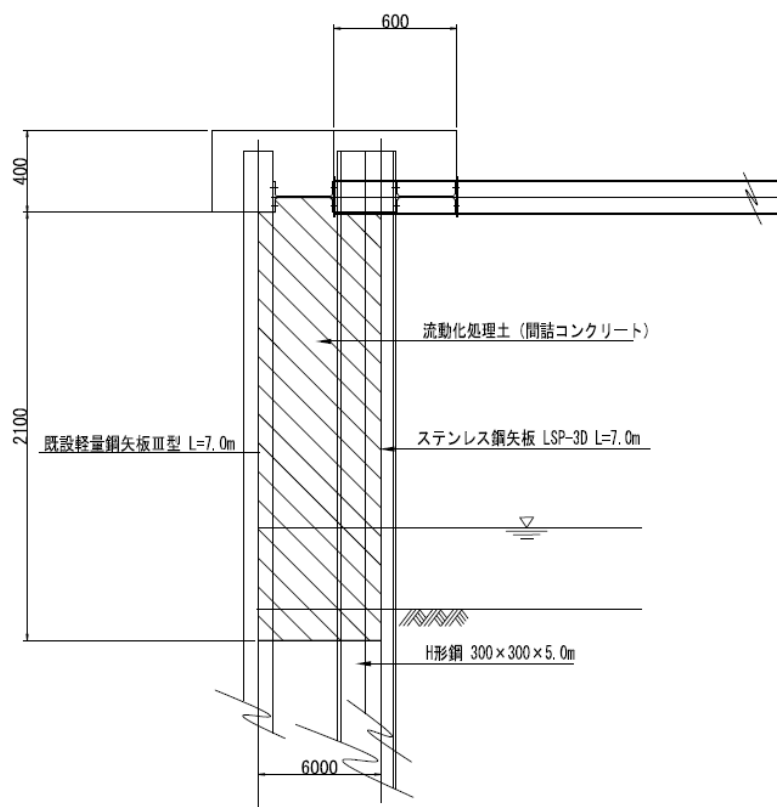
施工計画断面詳細図 (コンクリート打設)
